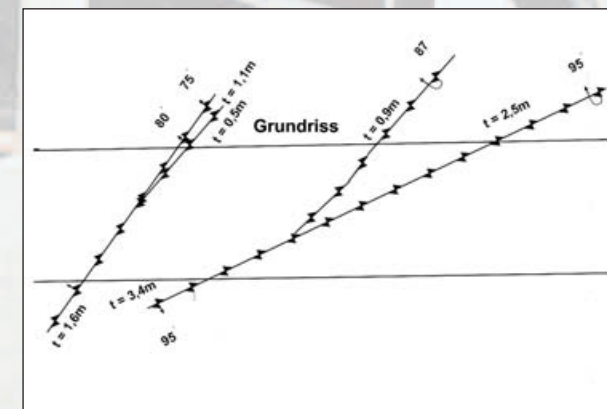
Störungsaufnahme Grundriss Bandstrecke
